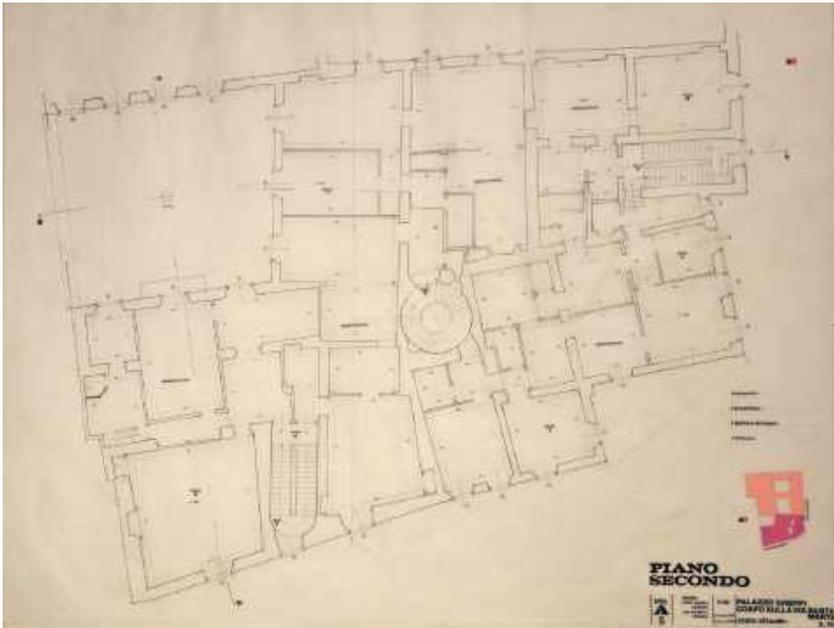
Corpo su via Santa Marta, pianta piano secondo, rilievo stato di fatto; tavola su lucido
